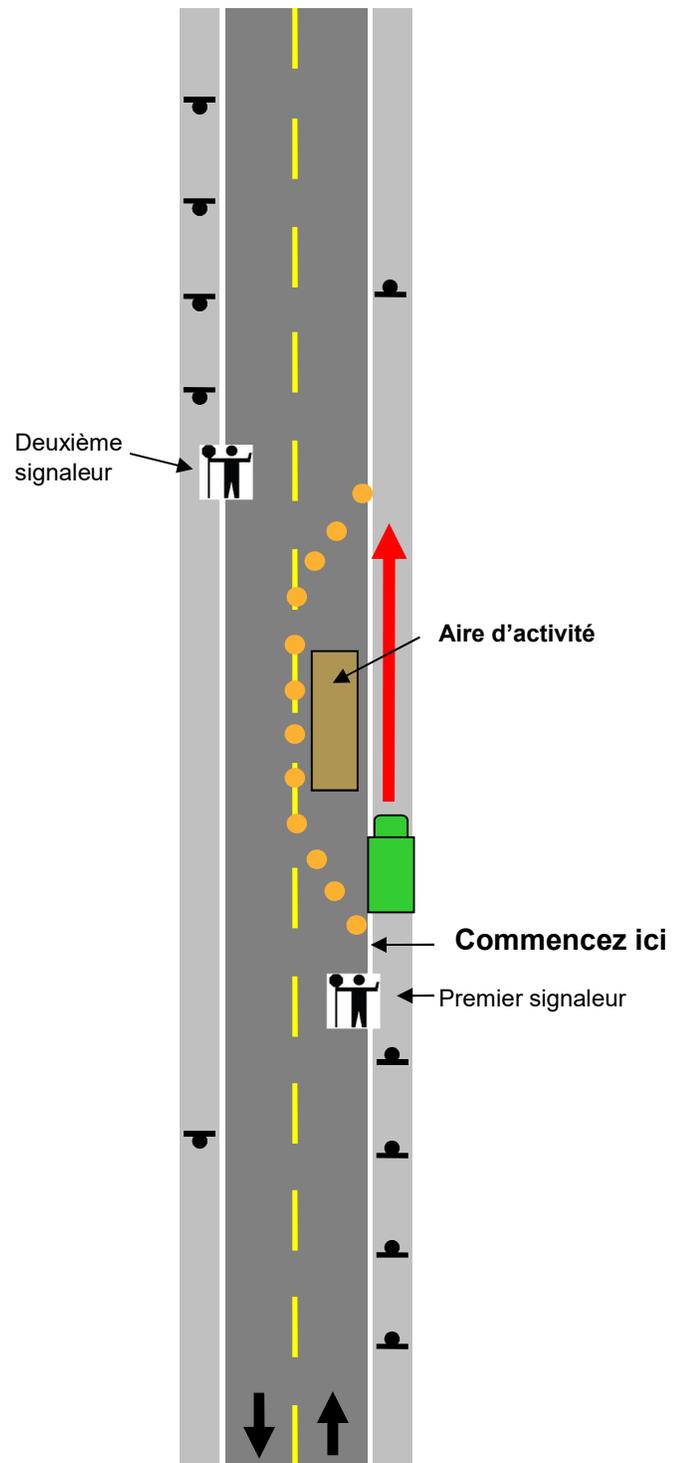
Installation pour la fermeture d'une voie (routes à deux voies)
